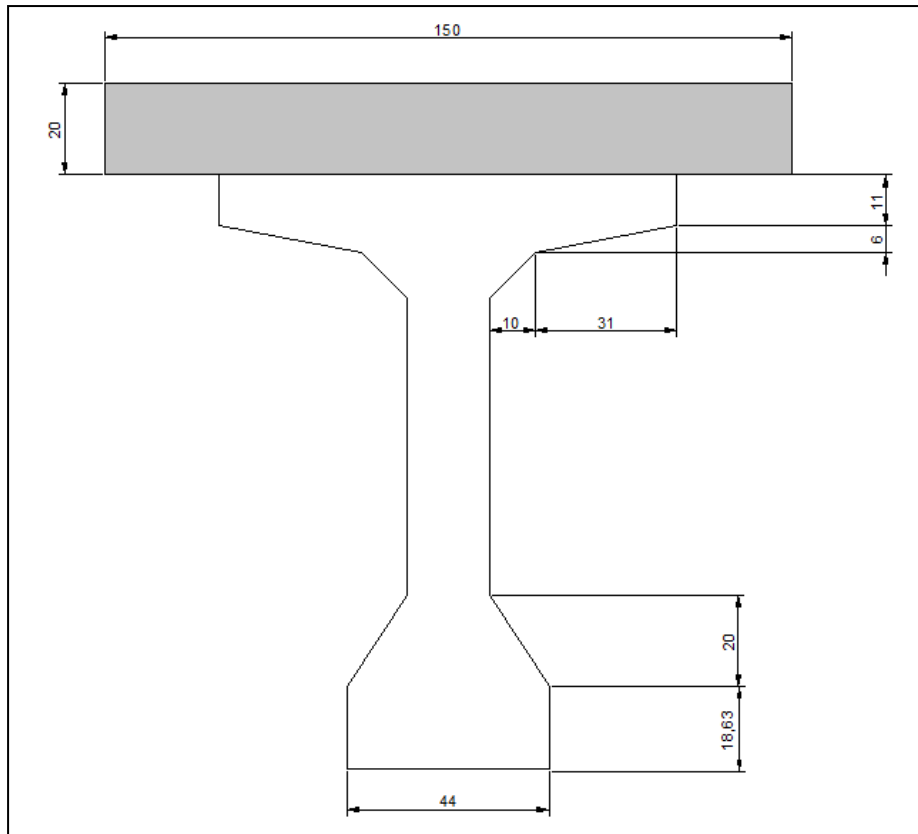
Troisième section de la poutre en BP plus l'hourdis général.
